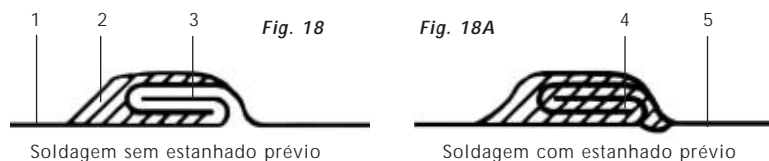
e 18A - Juntas de encaixe das lâminas de cobre soldadas.
